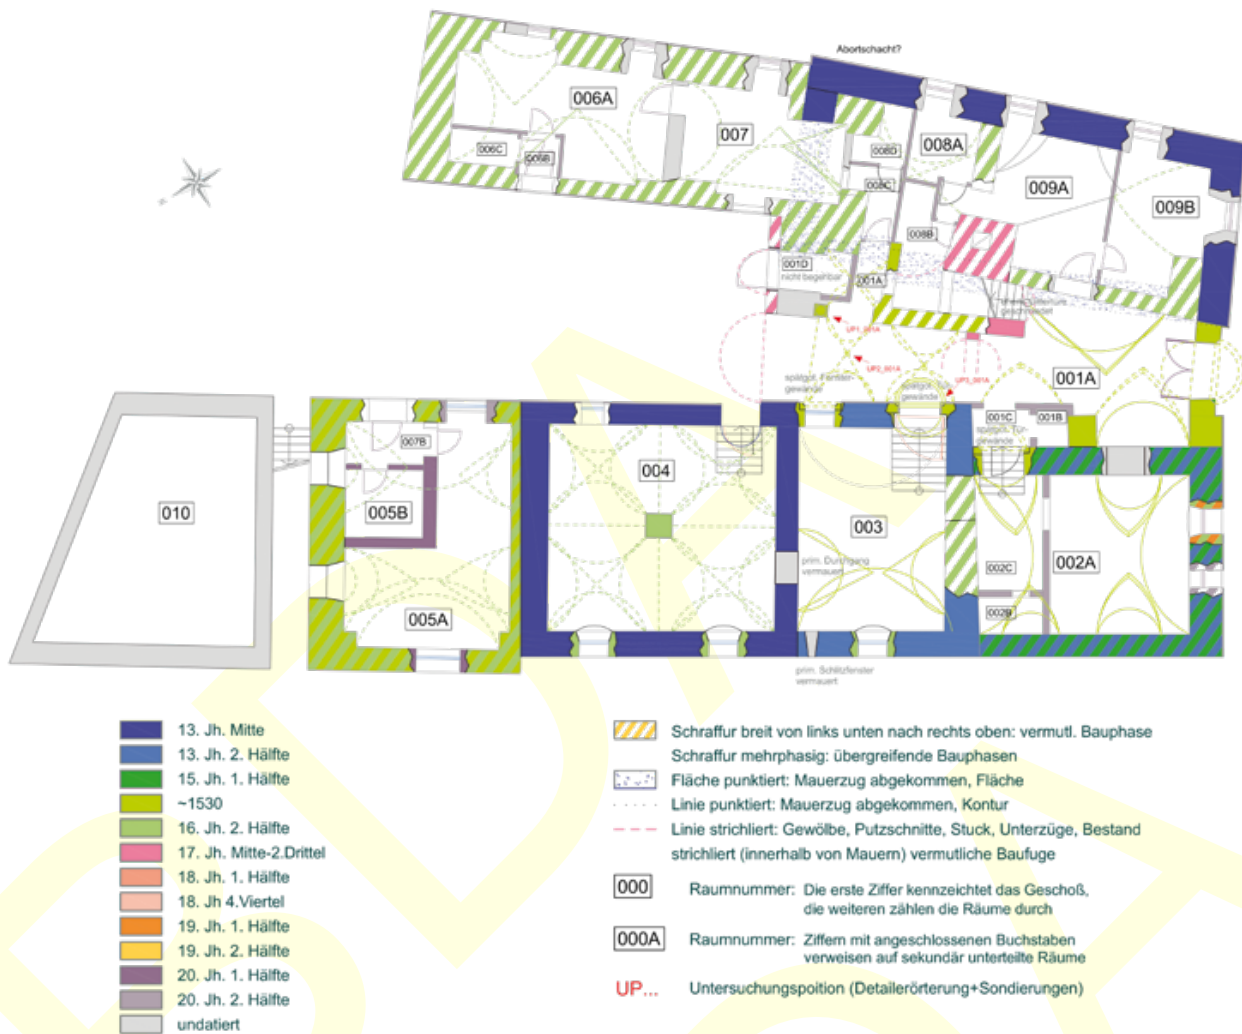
Friesach, Meidhaus. Baualterplan des Erdgeschoßes.
